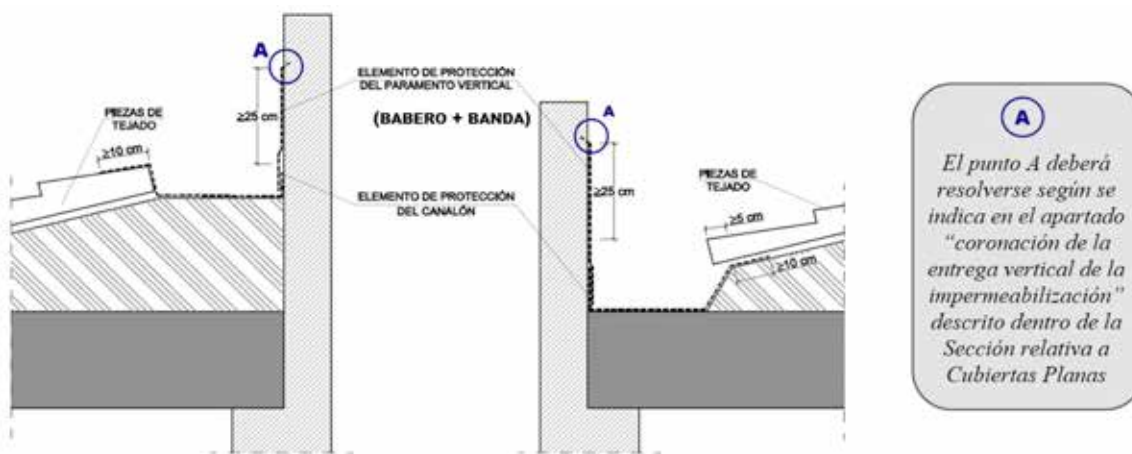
esquema del encuentro de un canalón empotrado con un faldón de cubierta inclinada: Izquierda: canalón en la parte superior del faldón (excepcional). Derecha: canalón en la parte superior del faldón (situación habitual).
